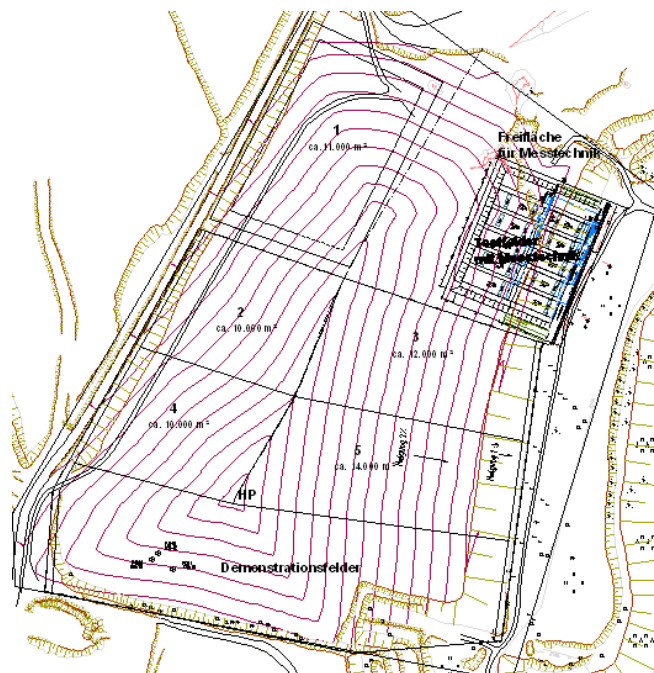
Lageplan (Entwurf) der Test- und Demonstrationsfelder auf dem Deponiebereich 6
